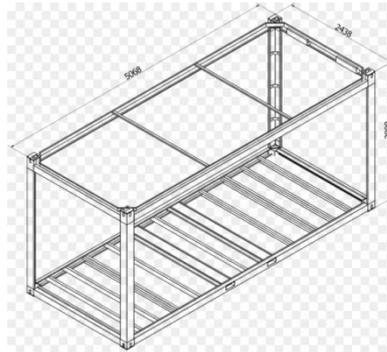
Vigas del panel inferiores (Fuente: https://www.academia.edu/8696945/PARTES_DEL_CONTENEDOR)
